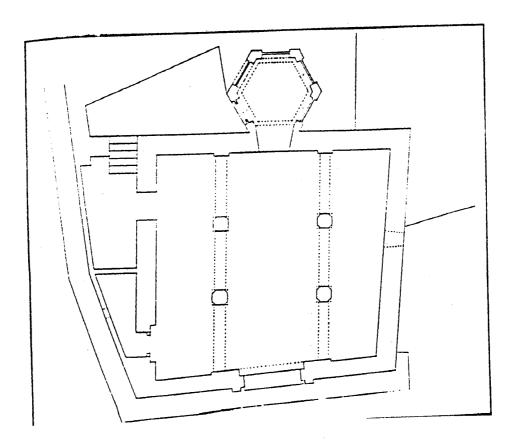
مسقط أفقي لمسجد بوفتاته في سوسه بتونس . (عن : Creswell) .
